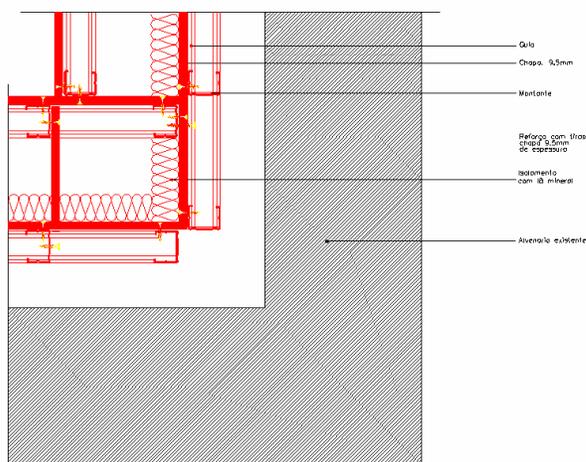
Detalhe em planta baixa da parede de alvenaria (existente) e da parede dupla de gesso acartonado (solução)
